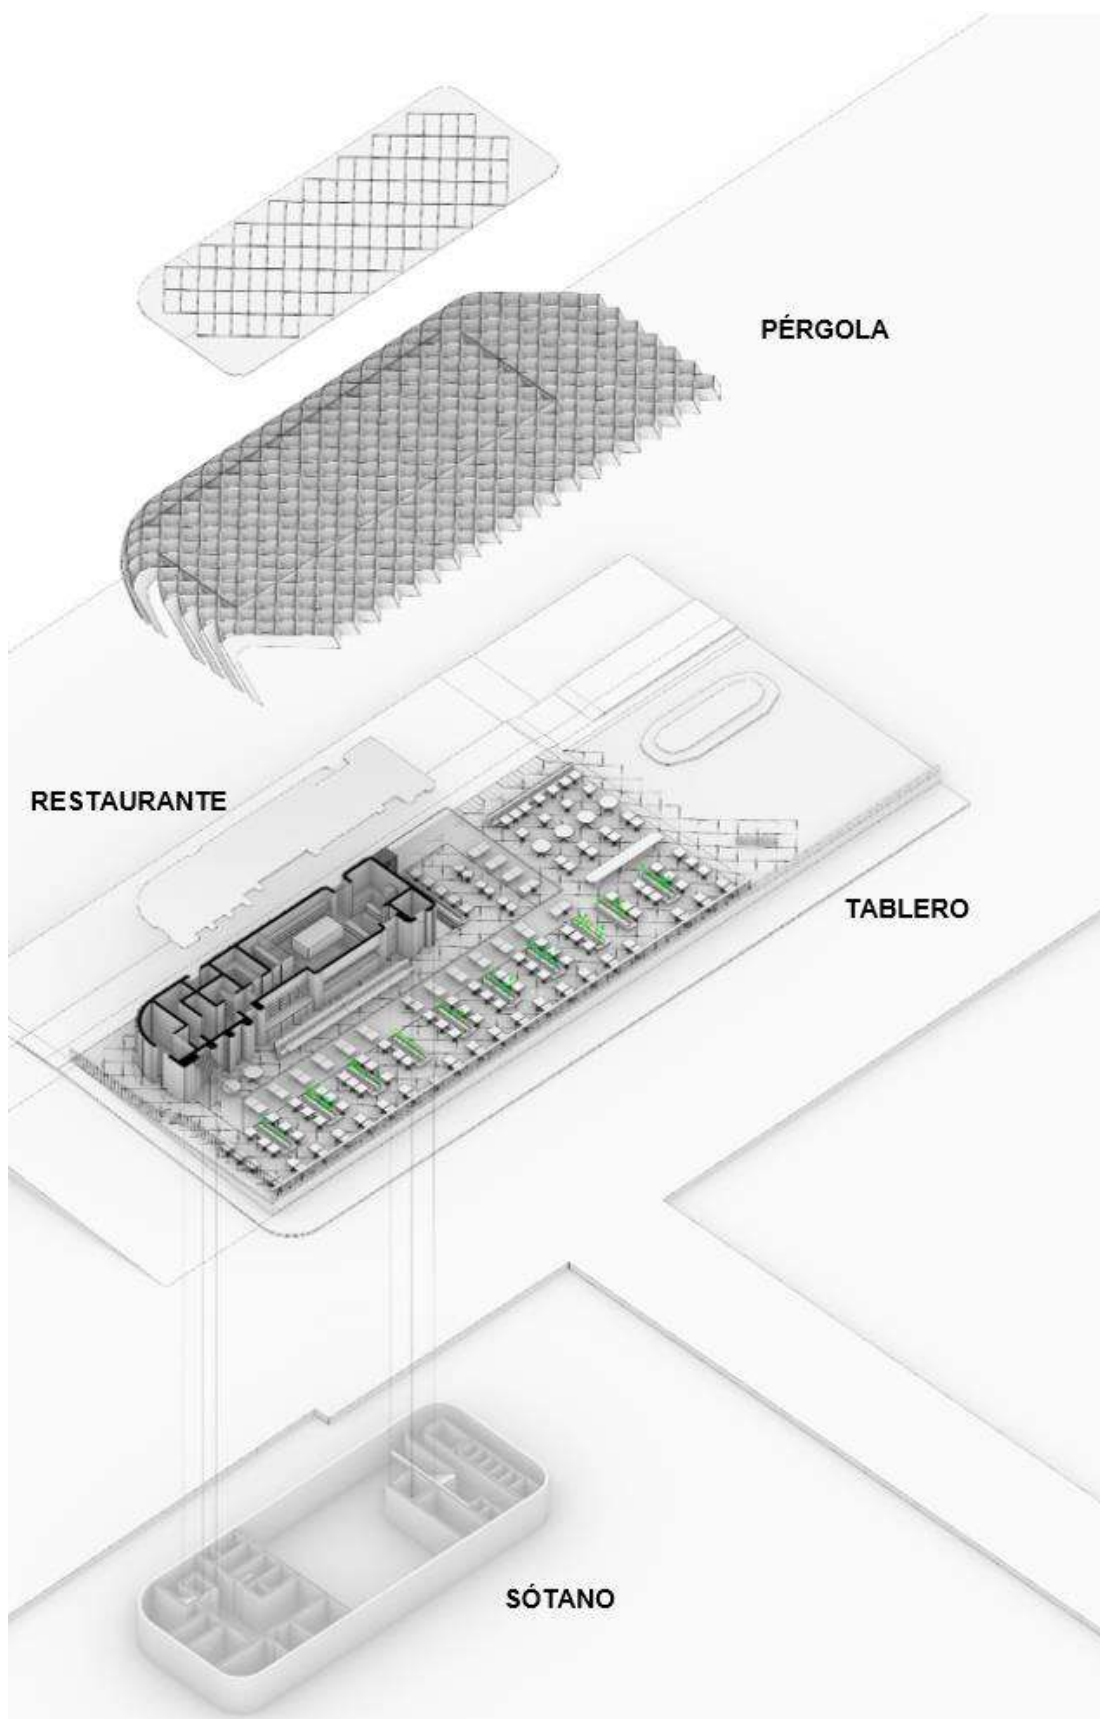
Axonometría esquema propuesta. Configuración del edificio.
